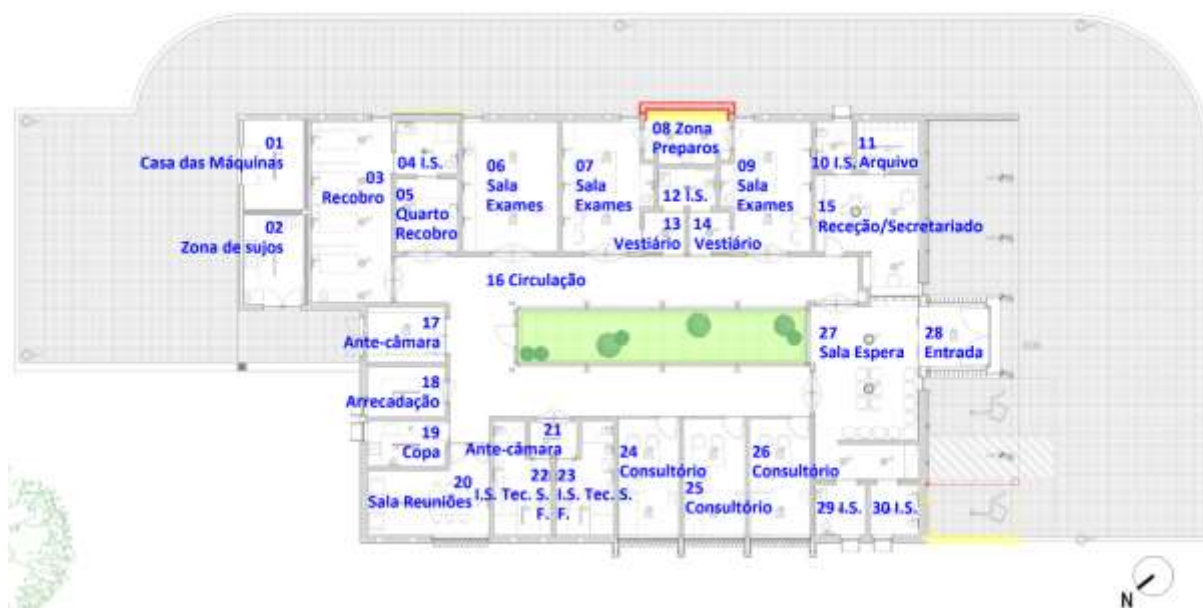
Planta do edifício. (Fonte: Documento de trabalho adaptado do projeto de arquitetura)
